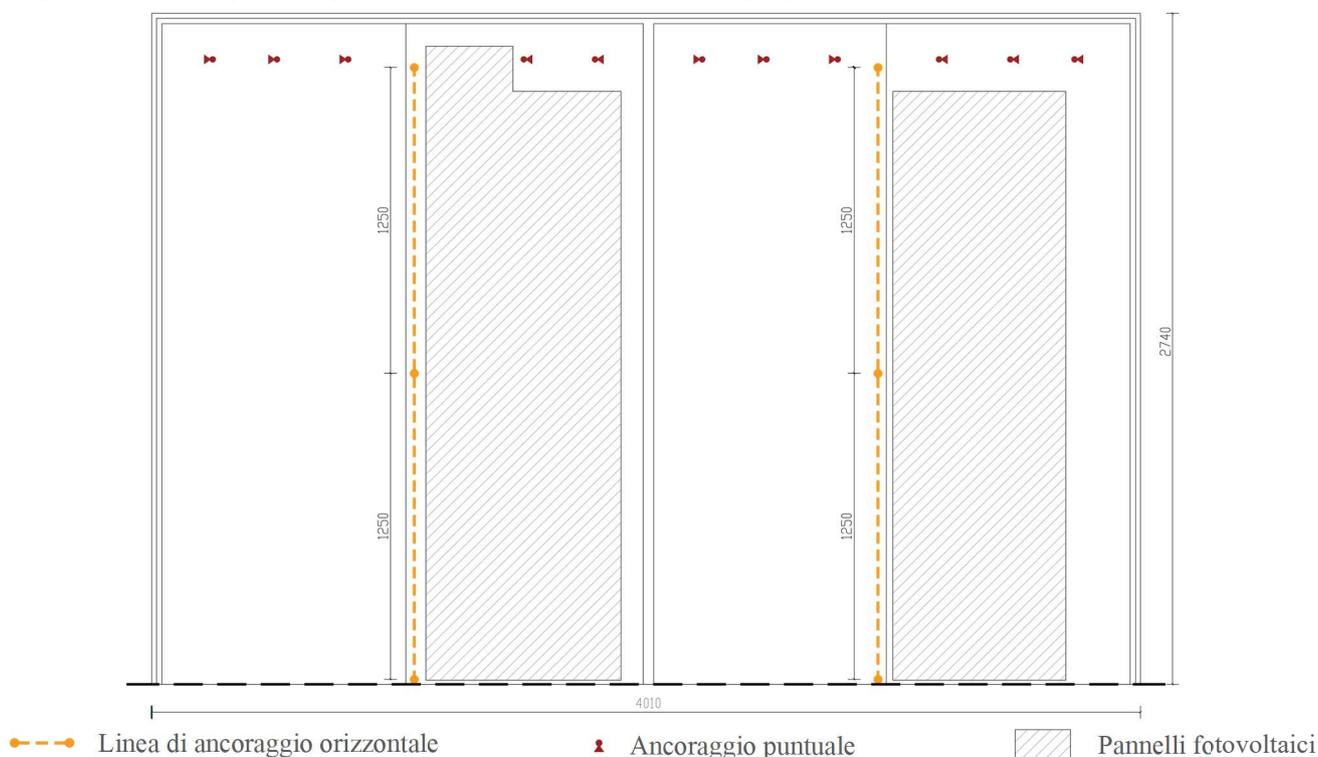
Pianta della copertura dell'edificio allo stato di fatto con individuazione della linea vita e dei pannelli fotovoltaici.
